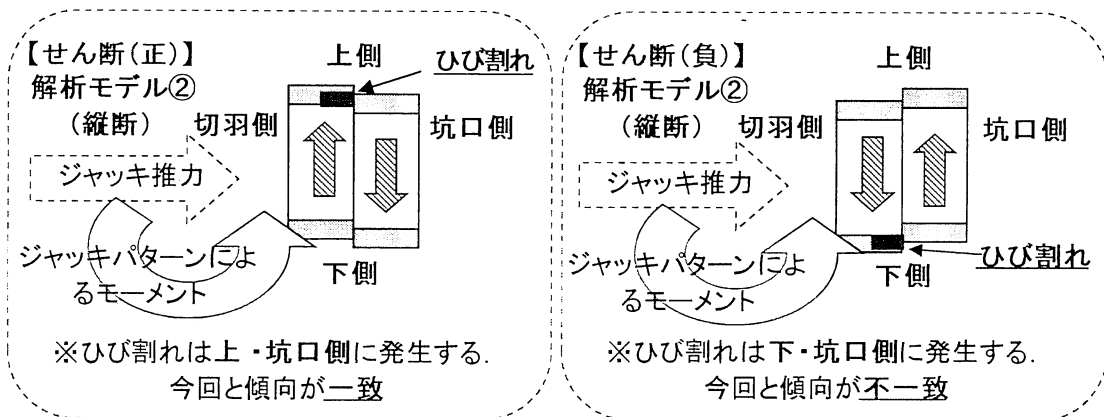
解析モデル②(縦断) ひび割れ発生箇所の整合性の確認
